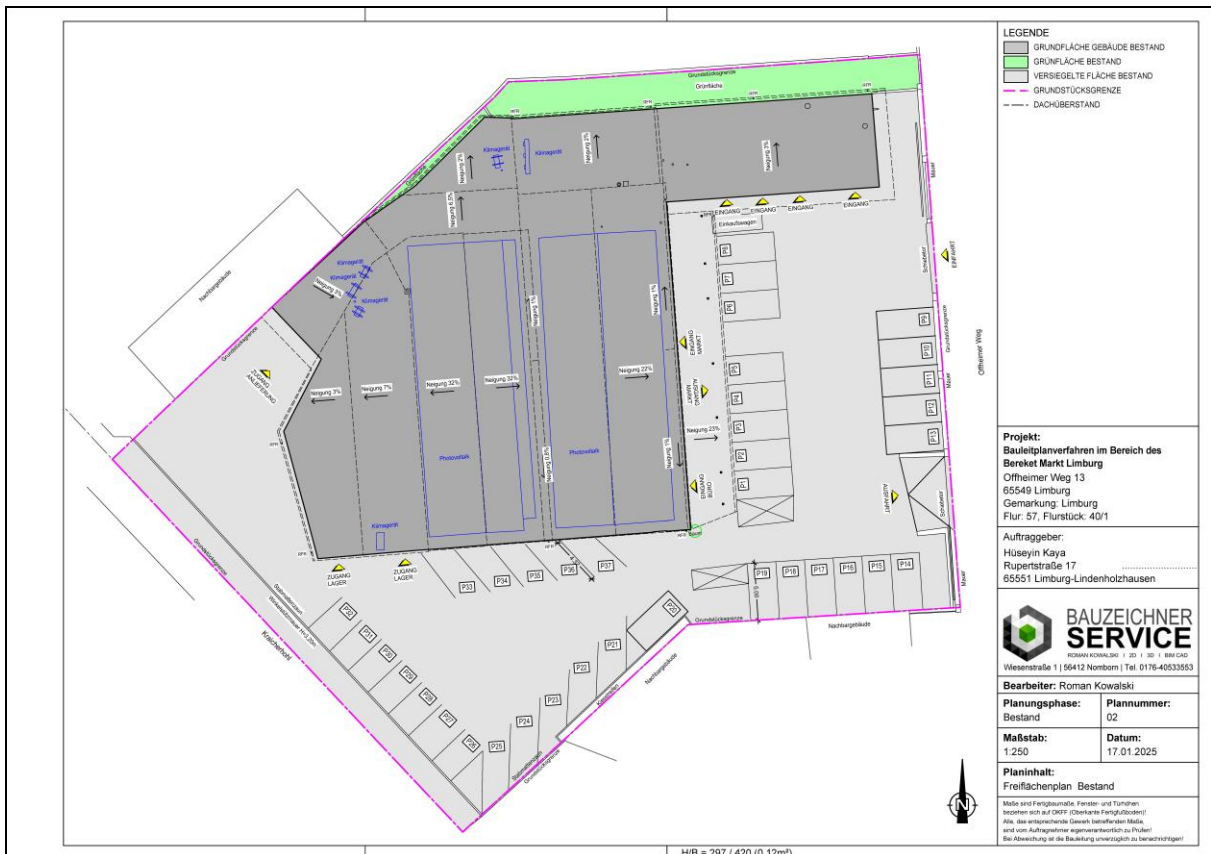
Freiflächenplan Bestand, Quelle: Bauzeichner Service, Roman Kowalski, 01/2025
